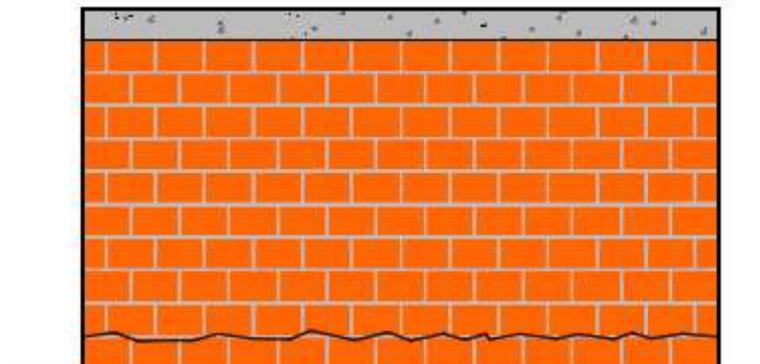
Fissuração horizontal na base da alvenaria por movimentações higroscópicas diferenciadas (Fonte: THOMAZ, 1989).
